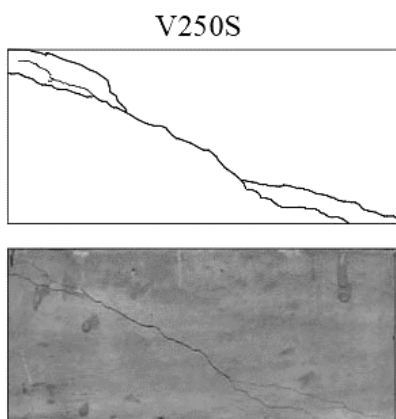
Padrão de fissuração da viga V250S.
